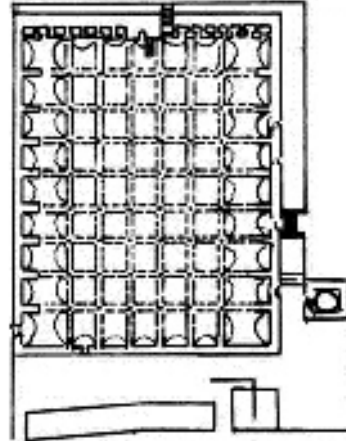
المسقط الأفقي لجامع صالح بن حمودة (عن مسعود البلوشي)
